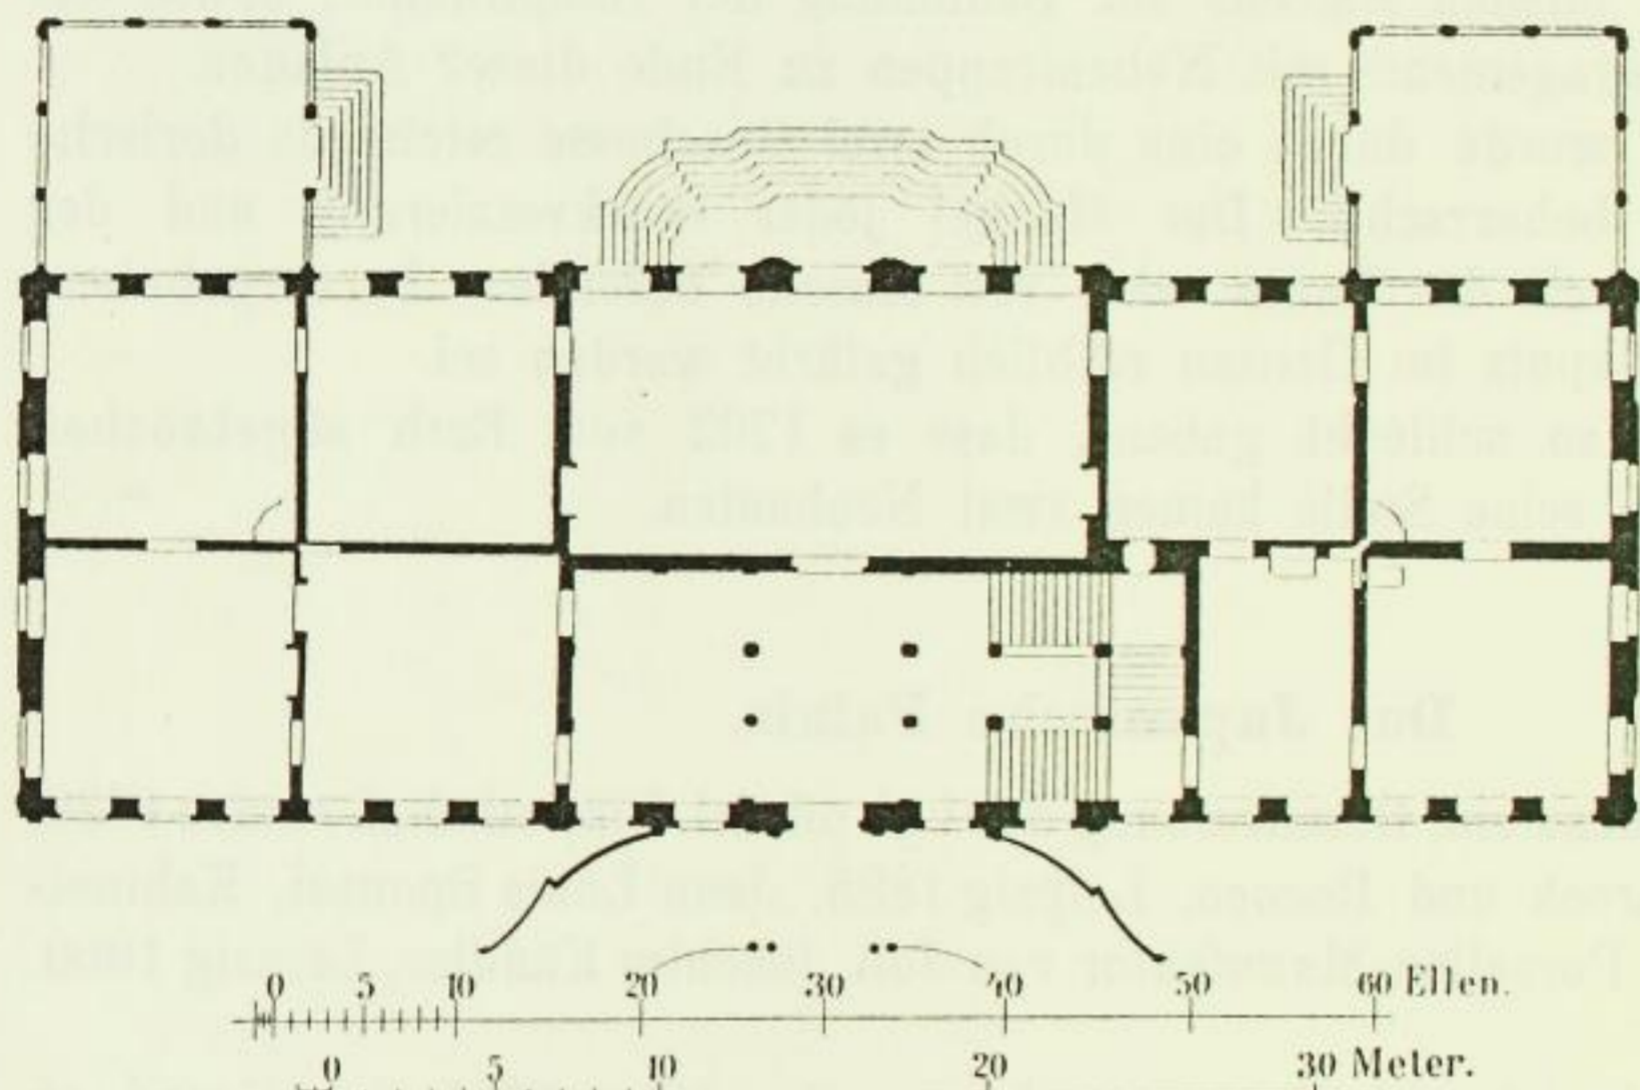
Holländisches Palais. Grundriss des Erdgeschosses.
